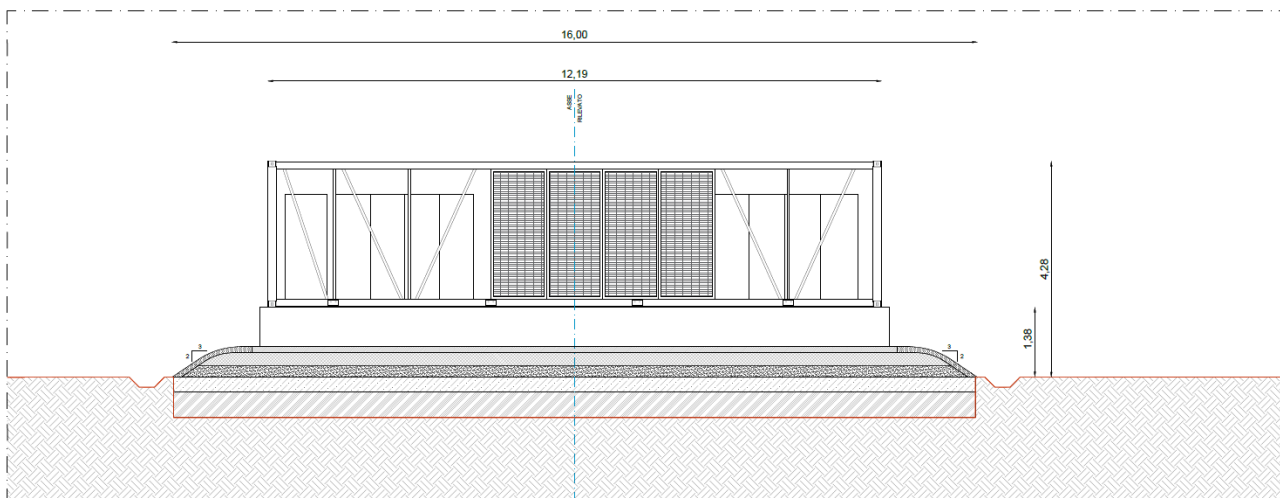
Prospetto longitudinale cabine di trasformazione MT/BT
